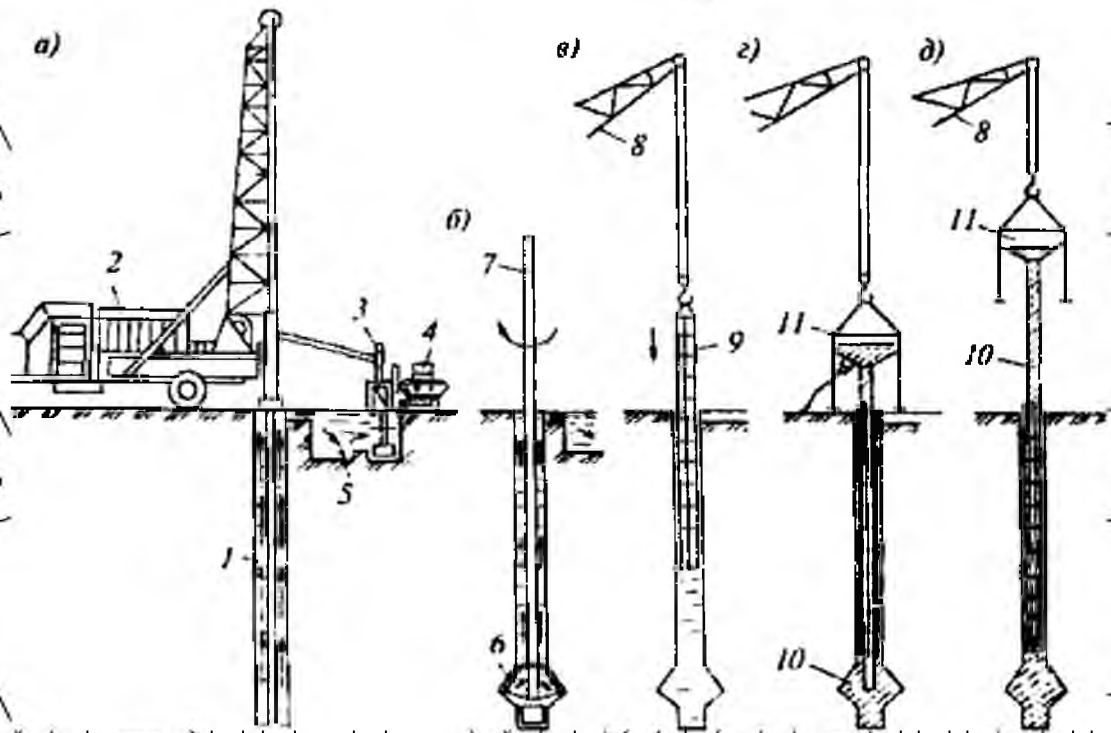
Технологічна схема влаштування буронабивних паль під глинистим розчином: а - буріння свердловини; б - влаштування розширеної порожнини; в - установка арматурного каркаса; г - установка в бробункера з бетонолітною трубою; д - бетонування свердловини методом ВПТ; 1 - свердловина; 2 - бурова установка; 3 - насос; 4 - глинозмішувач; 5 - приямок для глинистого розчину; 6 - розширювач; 7 - штанга; 8 - стріловидний кран; 9 - арматурний каркас; 10 - бетонолітна труба; 11 - вібробункер
